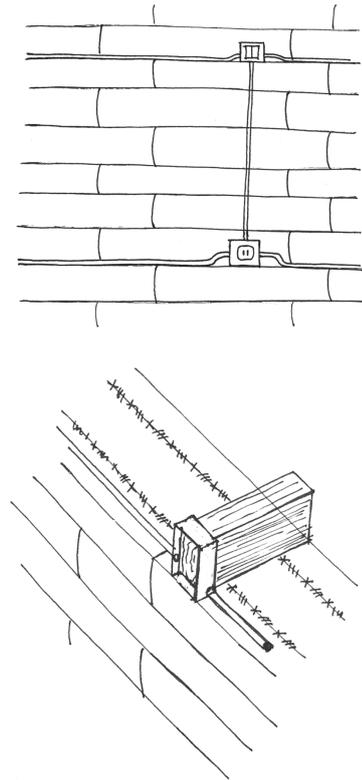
Colocación de tubos de las instalaciones de electricidad durante el levantamiento del muro. Elaboración propia basada en imágenes de Ceramic Houses & Earth Architecture
